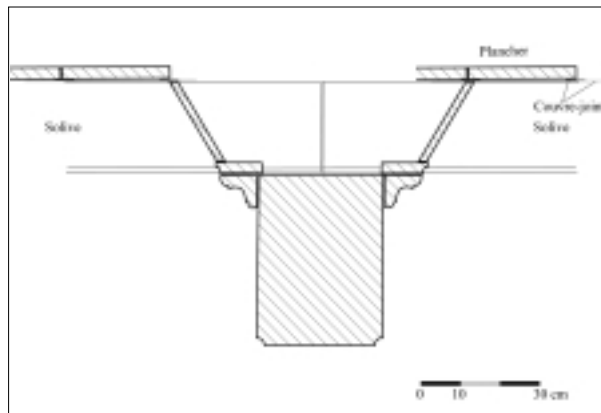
PLAFOND DU REZ-DE-CHAUSSÉE DU CORPS-ARRIÈRE. Relevé Sandrine Conan, HADÈS.
